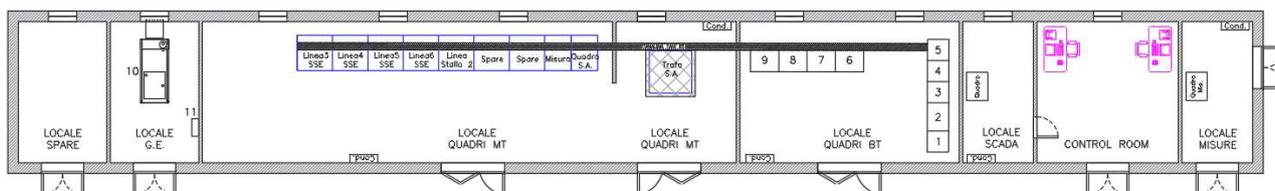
Stazione Elettrica Utente Stallo 2 – Planimetria
